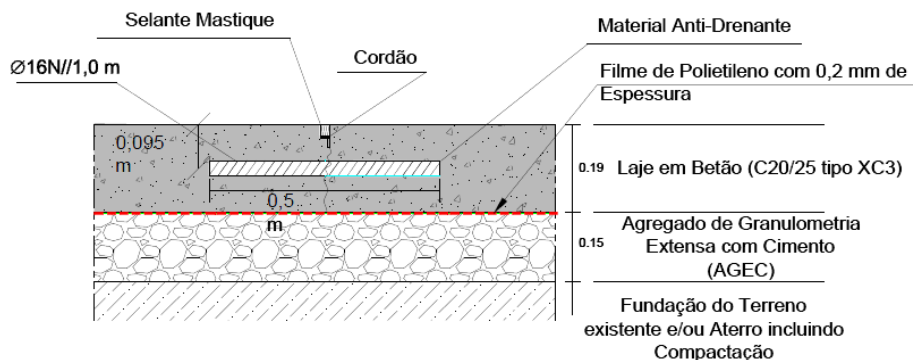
Constituição de um Pavimento Rígido (Fonte: Pereira et al., 2013)
